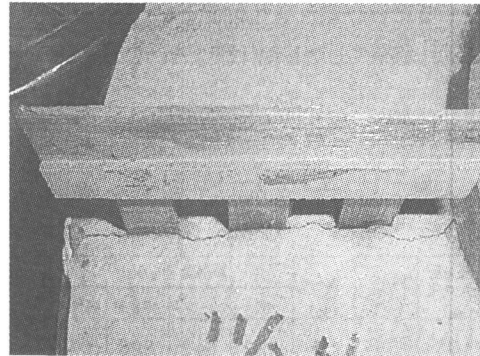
ひび割れ発生状況 (Dシリーズ)
